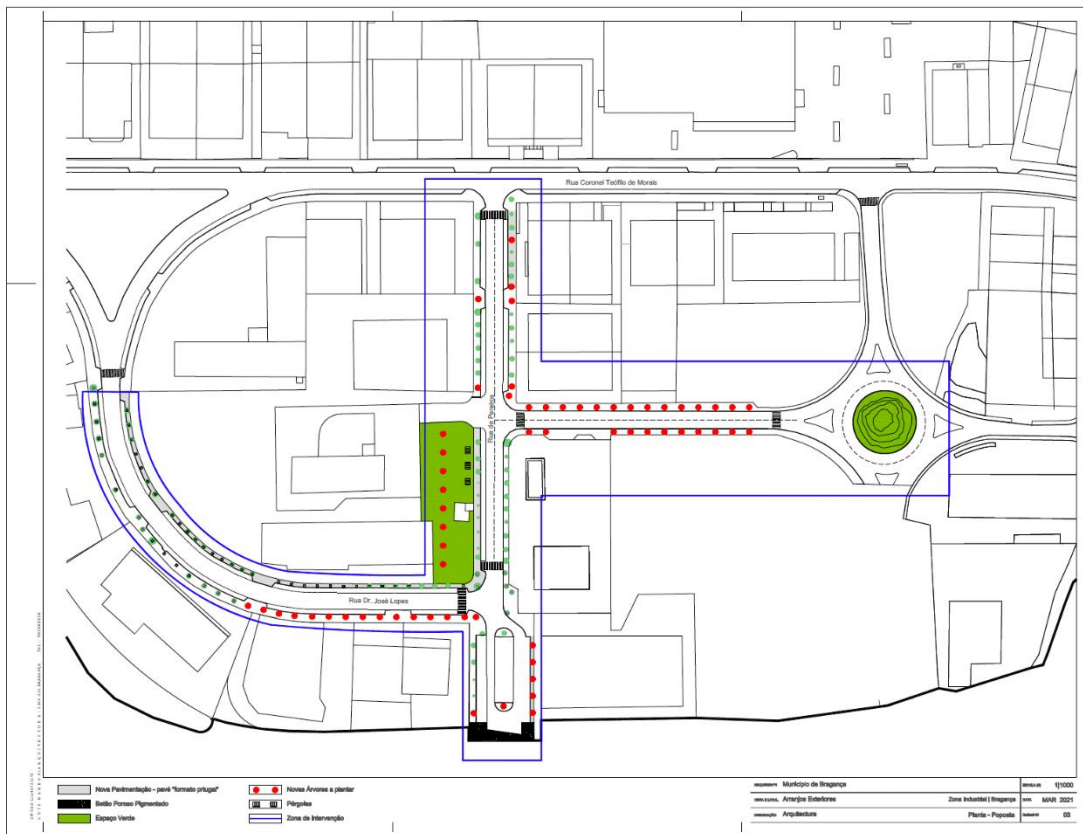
Planta de intervención. Fuente: Luis M. Cordeiro de Barros.
